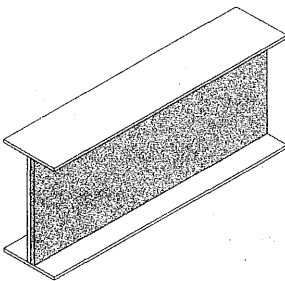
10. Refuerzos metálicos de vigas: refuerzos de alas con chapas atornilladas.
